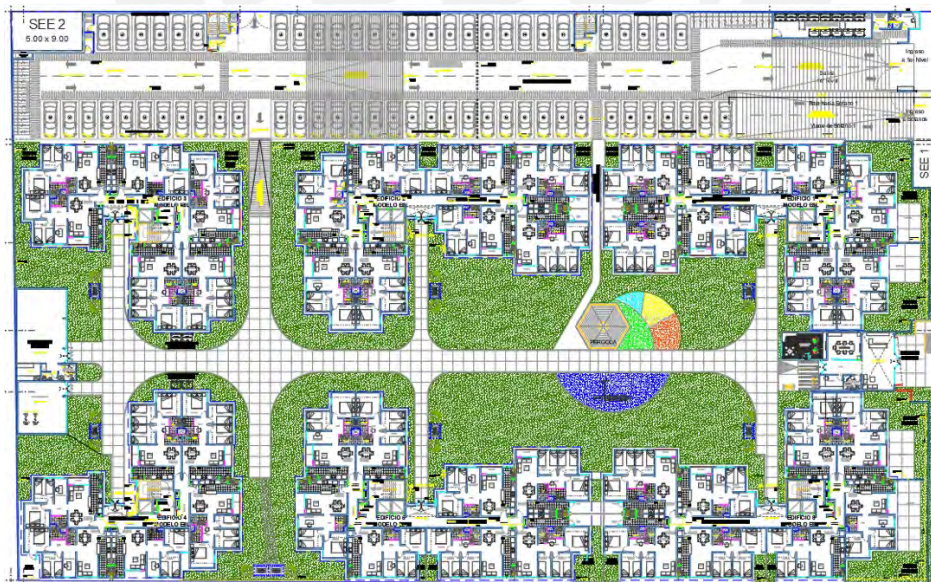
Planimetría del proyecto Villanova Etapa 3.
